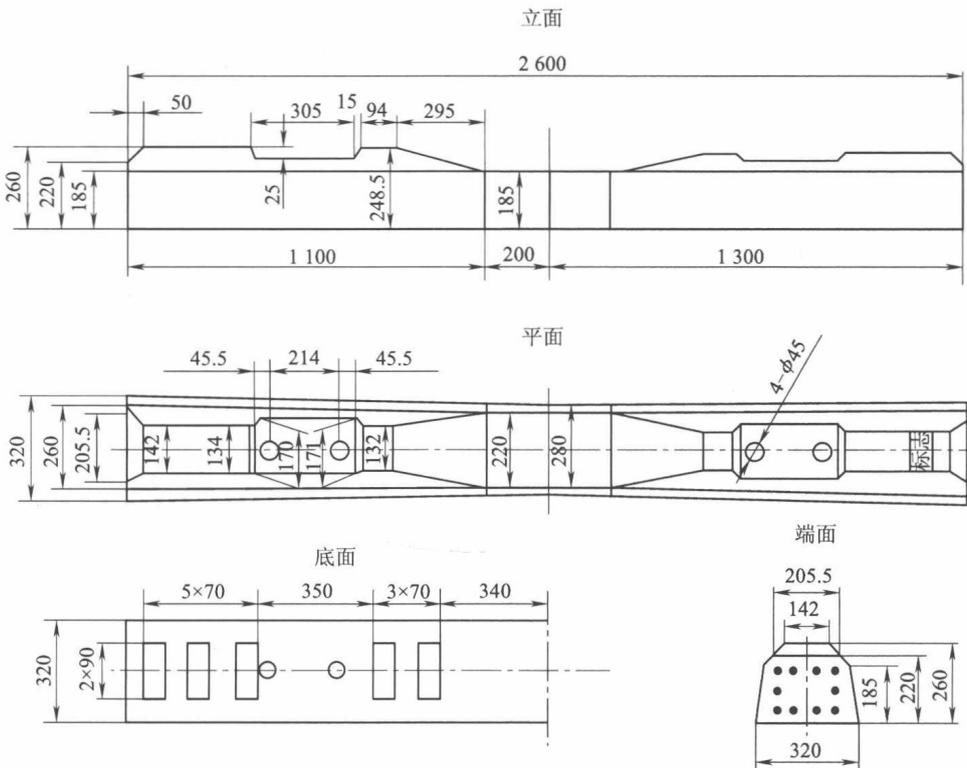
III 型有挡肩混凝土枕(单位:mm)
